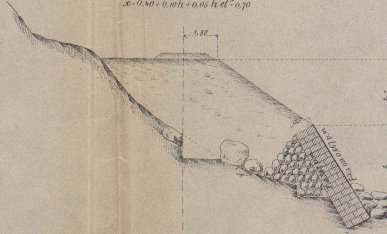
Mur de soutènement en maçonnerie de pierres sèches pour remblai.
